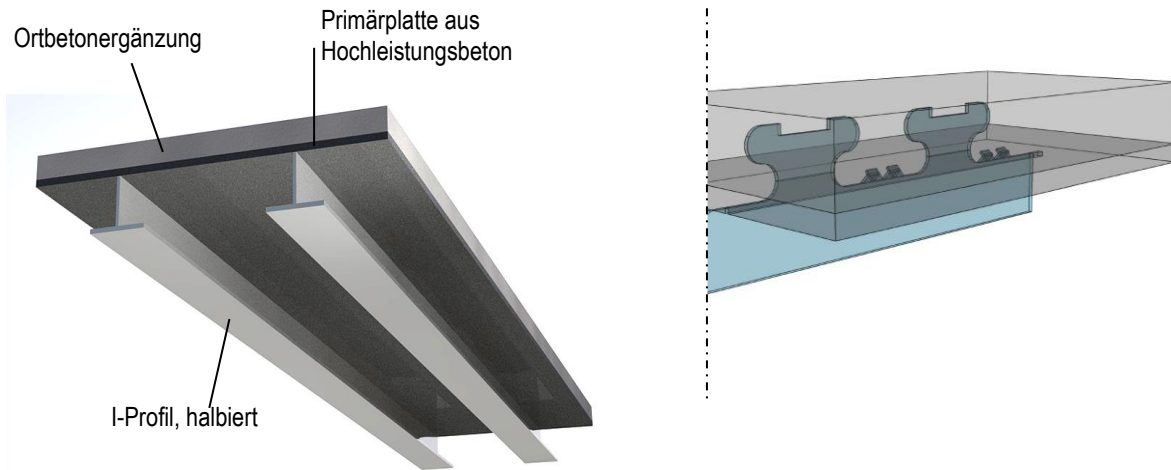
Darstellung des Deckensystems mit Ortbetoneergänzung, Hochleistungsbeton (HPC) und Stahlträgern: baustellengerechte Ausführung als PI-Platte (links) und Ausschnitt aus dem Verbundsystem (rechts)
